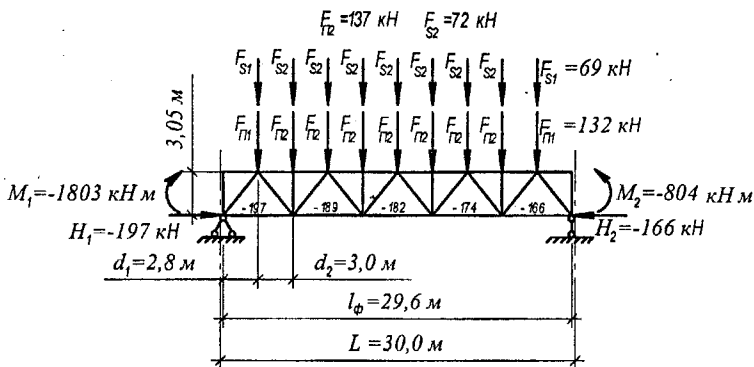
Розрахункова схема ферми і схема навантажень
